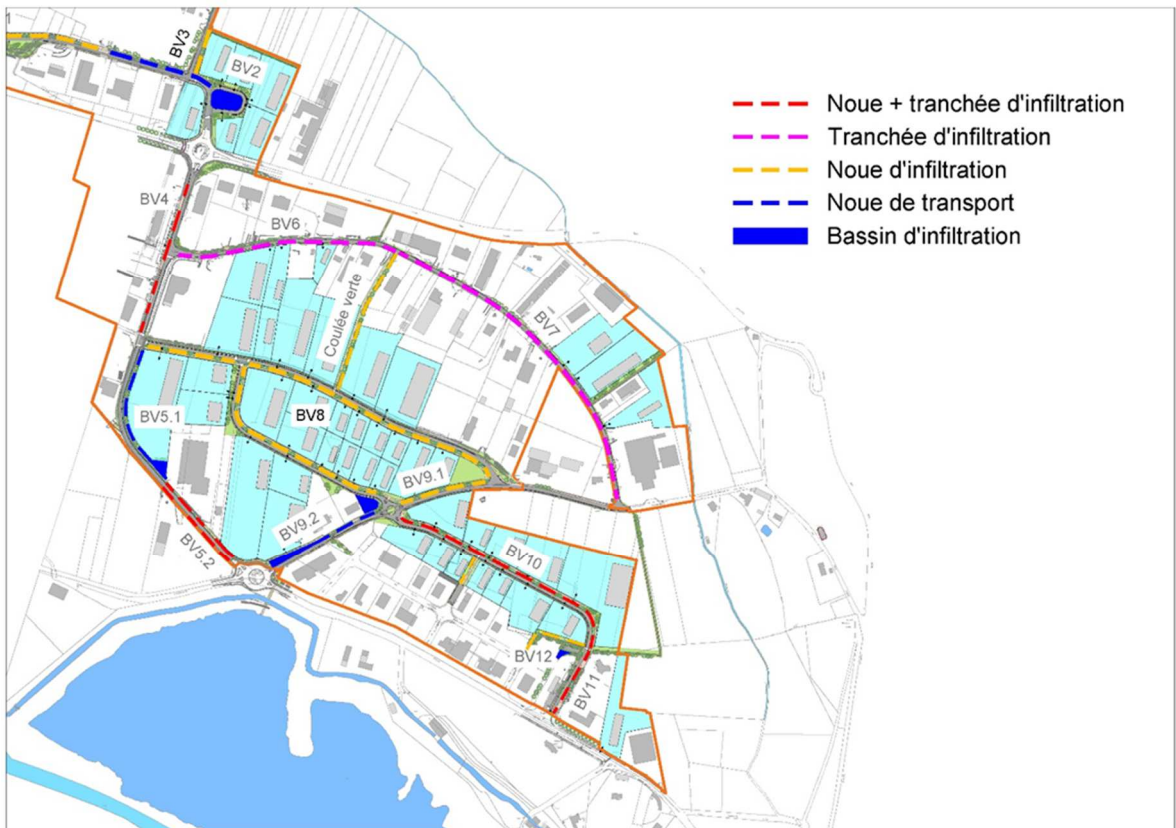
Plan de synthèse des ouvrages prévus pour la gestion des eaux pluviales – Secteur Sud (Source : Etudes d'Avant-Projet, janvier 2023)
